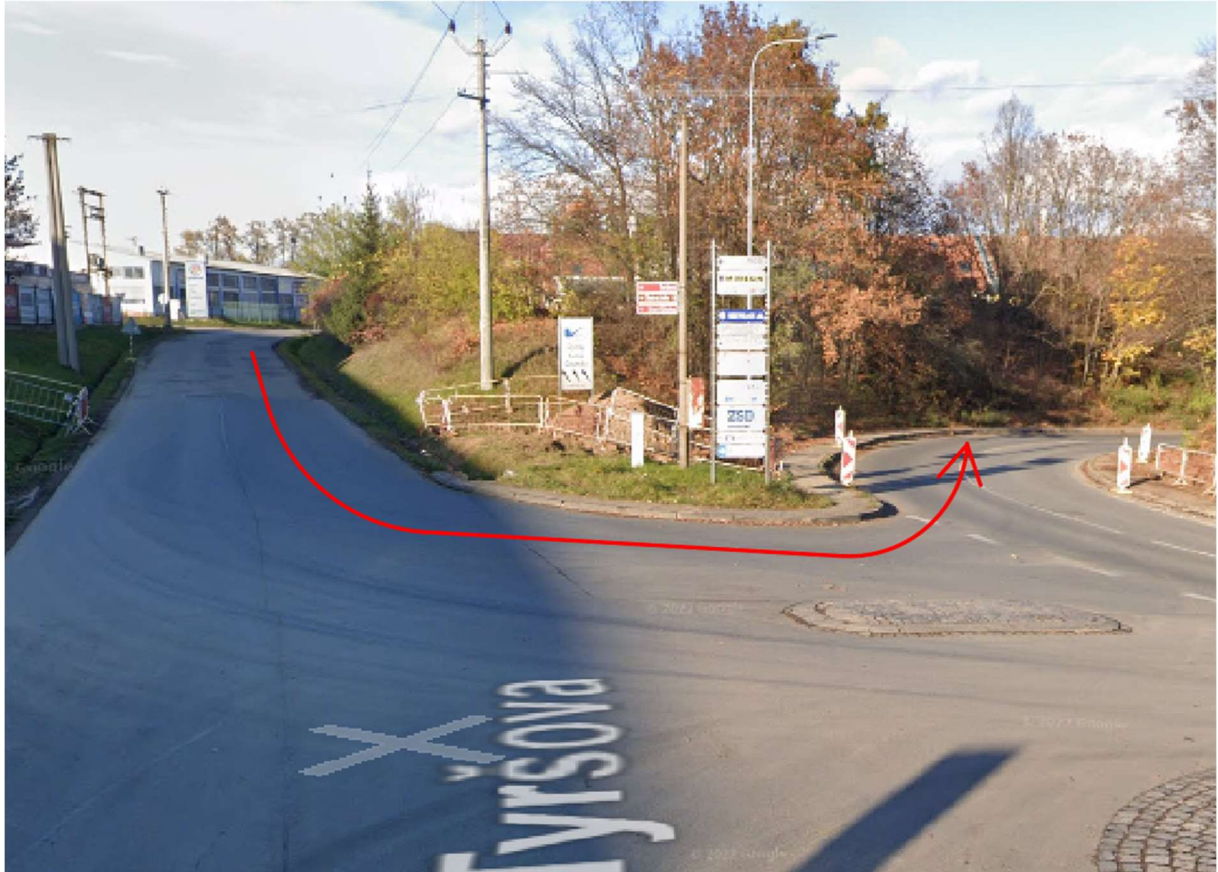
[10] Doprava pilotovací vrtné soupravy z firmy Pilot servise s.r.o.
